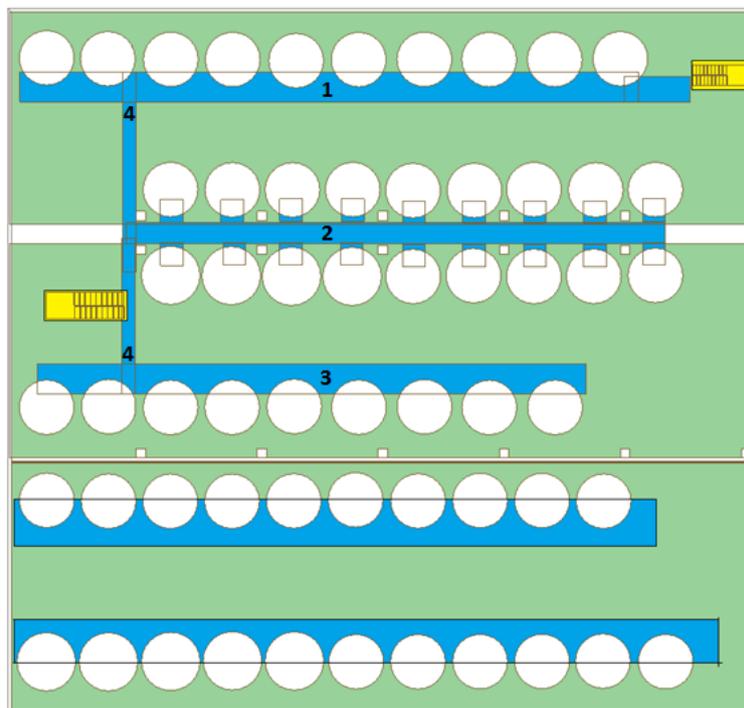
Vista en planta del almacén para detallar pasarelas. Fuente: Elaboración propia.
